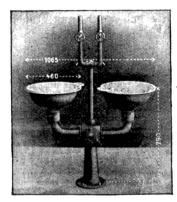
Seitenanficht einer zweiseitigen Unlage mit Beden von 400 mm Ø außen grundiert
